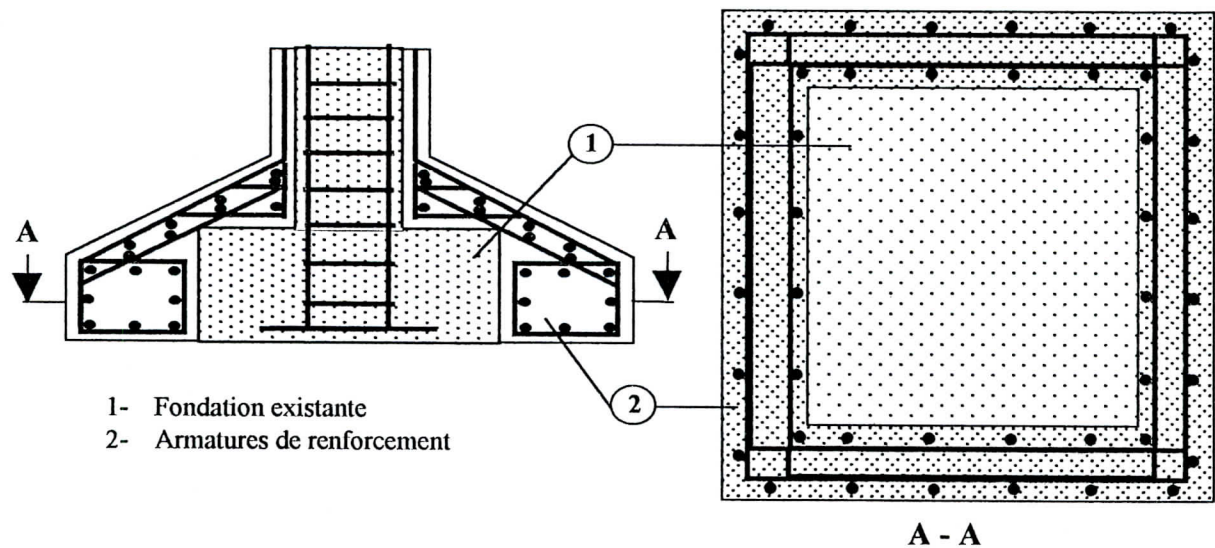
Renforcement des fondations – cas où le poteau est déjà renforcé par gainage [15]
